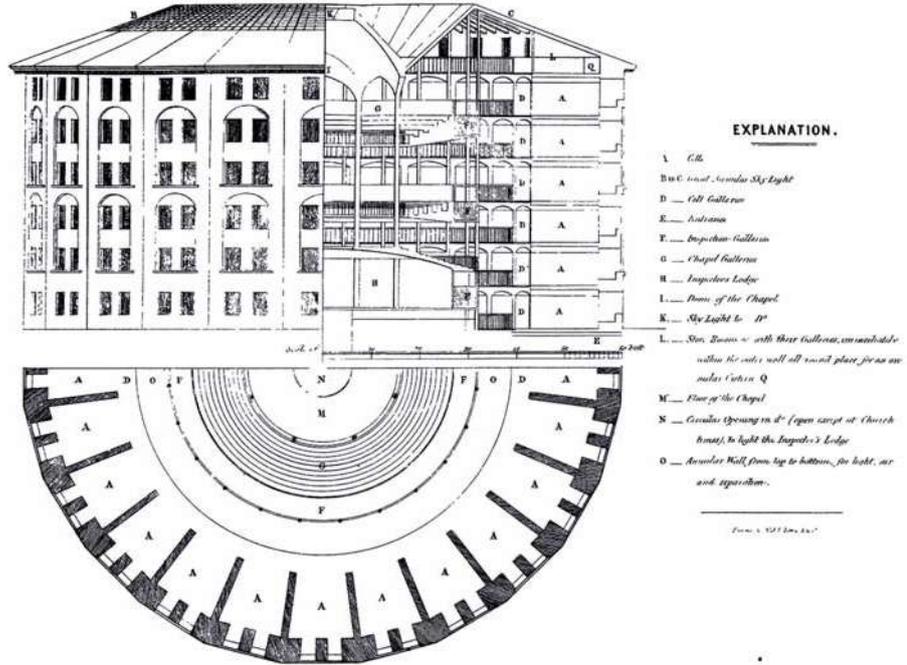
Teilschnitt-, grundriss Prinzip Panopticon
